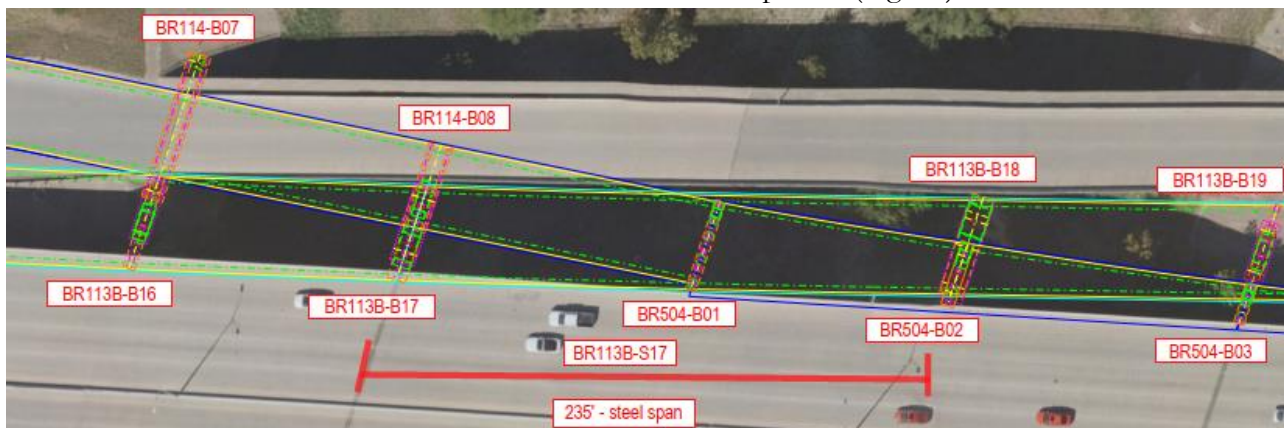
Planta de situación de los puentes 113B, 114 y de los puentes existentes de las calzadas principal y de servicio de la I-35.
